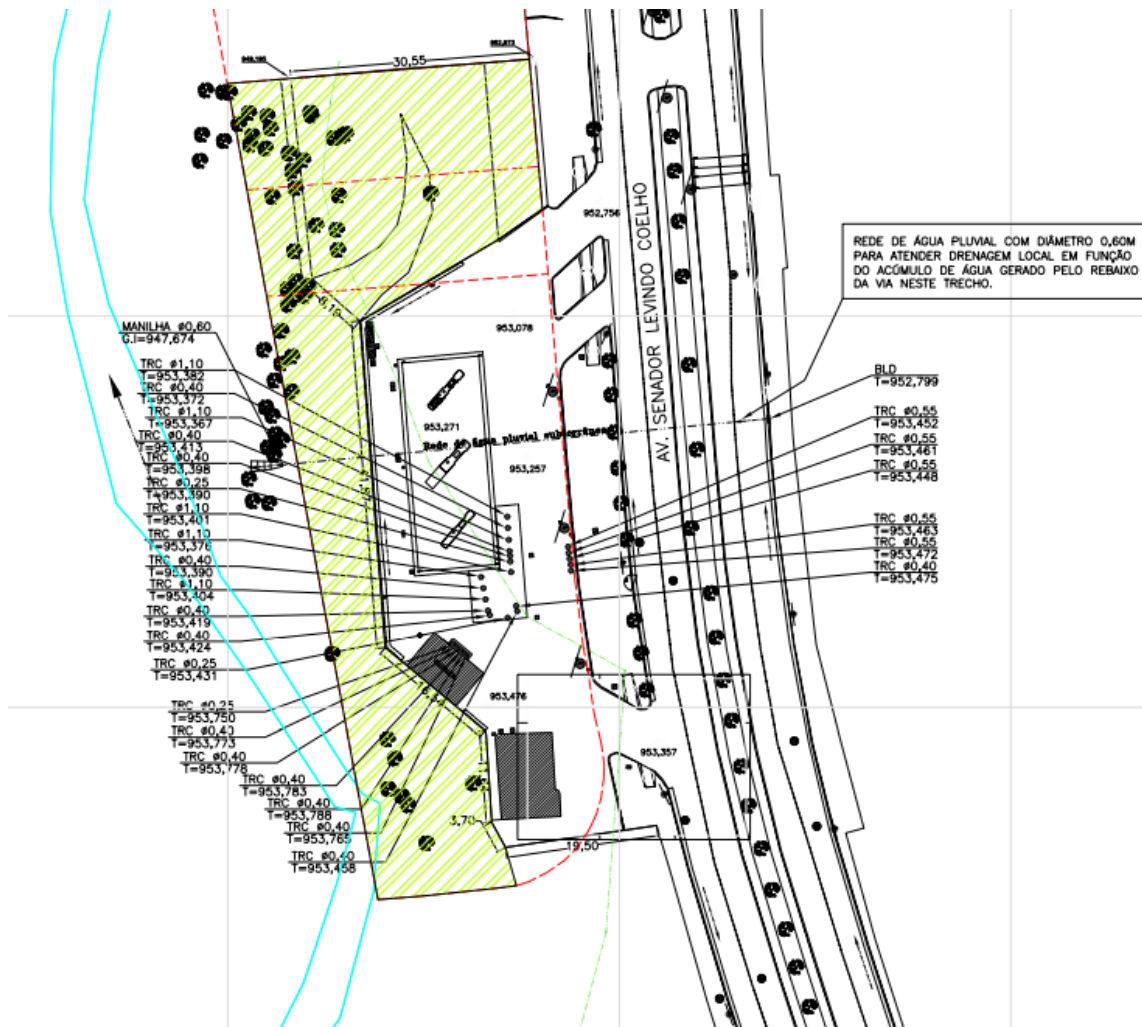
Projeção da APP no empreendimento, englobando as edificações e parte da pista de abastecimento.
